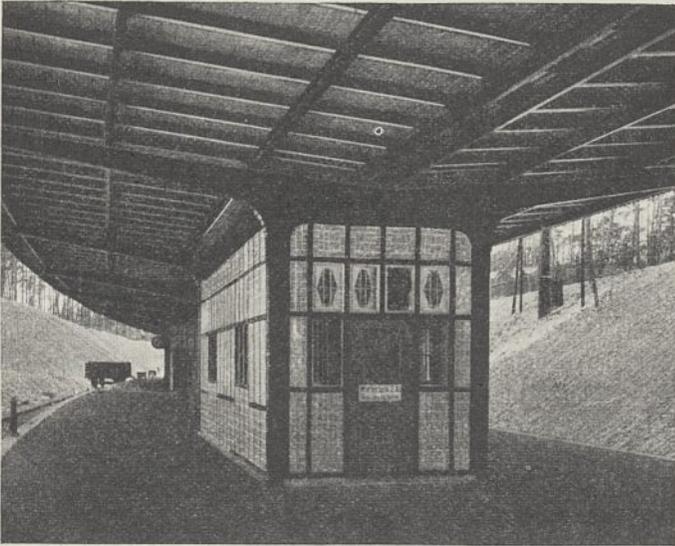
Warteraum für einstiellige Bahnsteigüberdachung.
